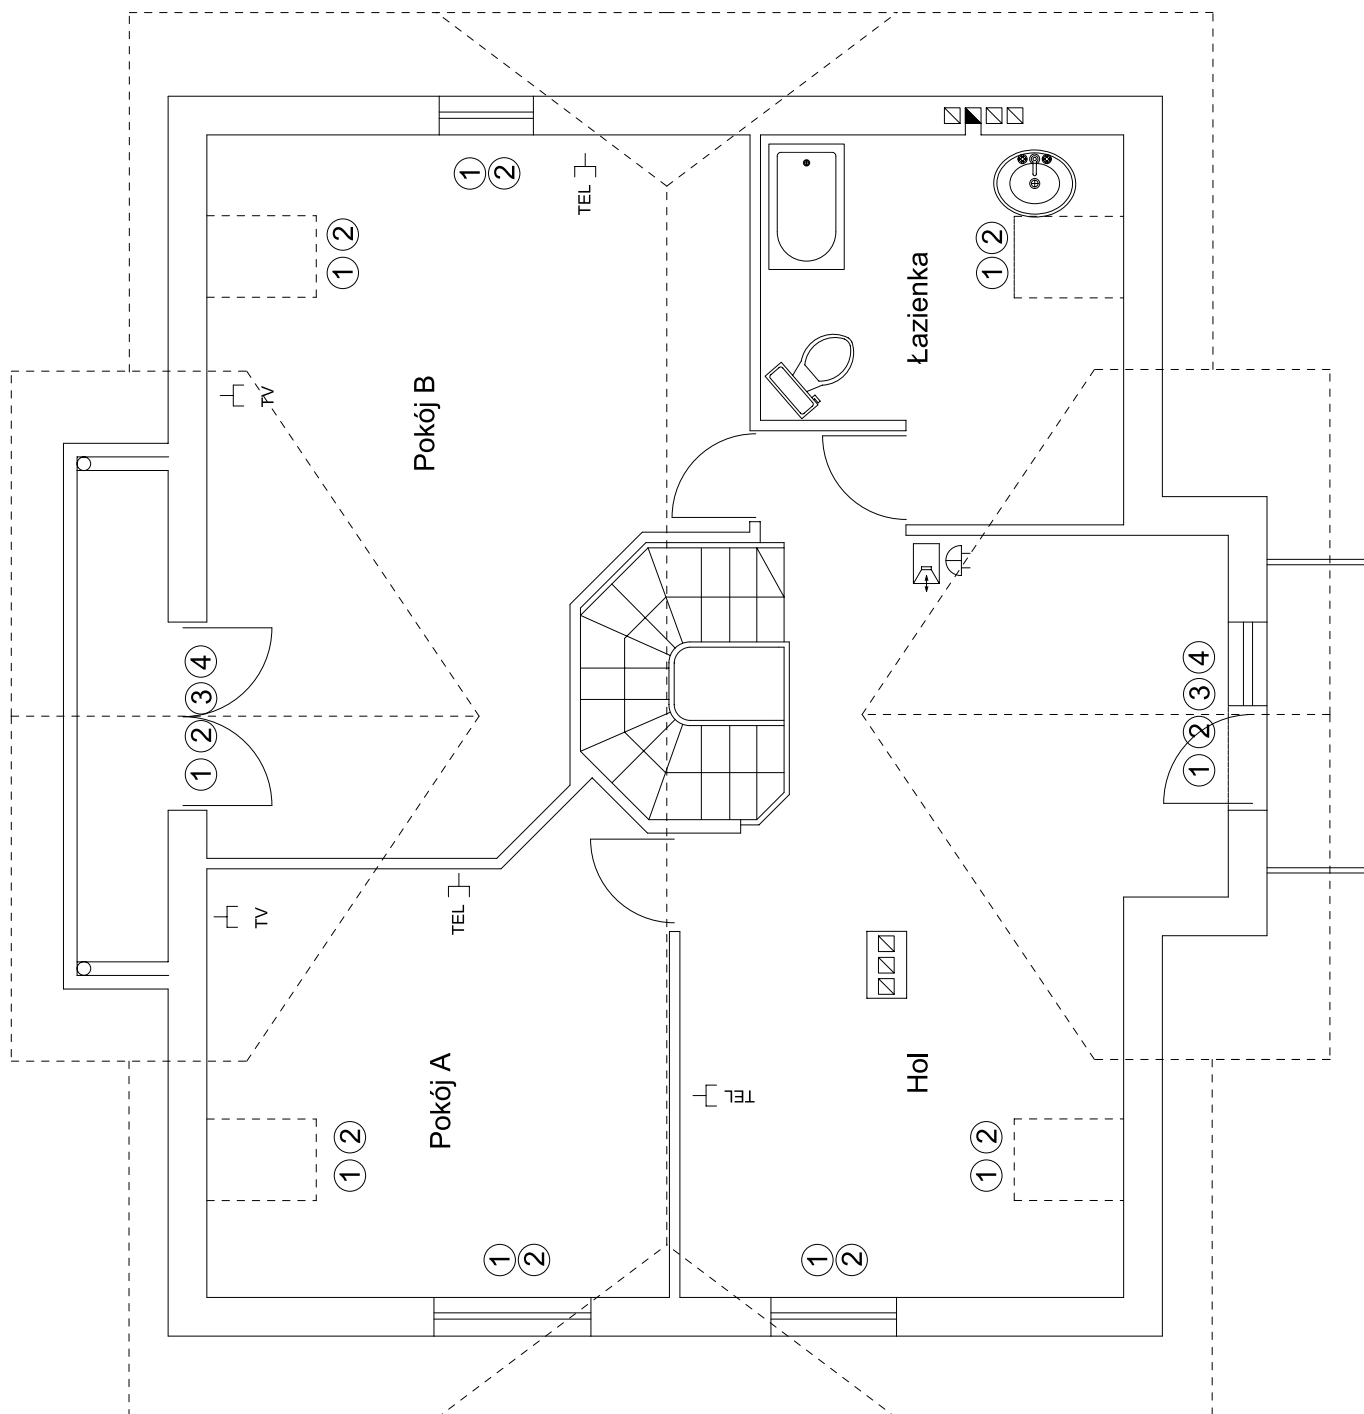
/14 Plan instalacji grzewczej - PODDASZE
